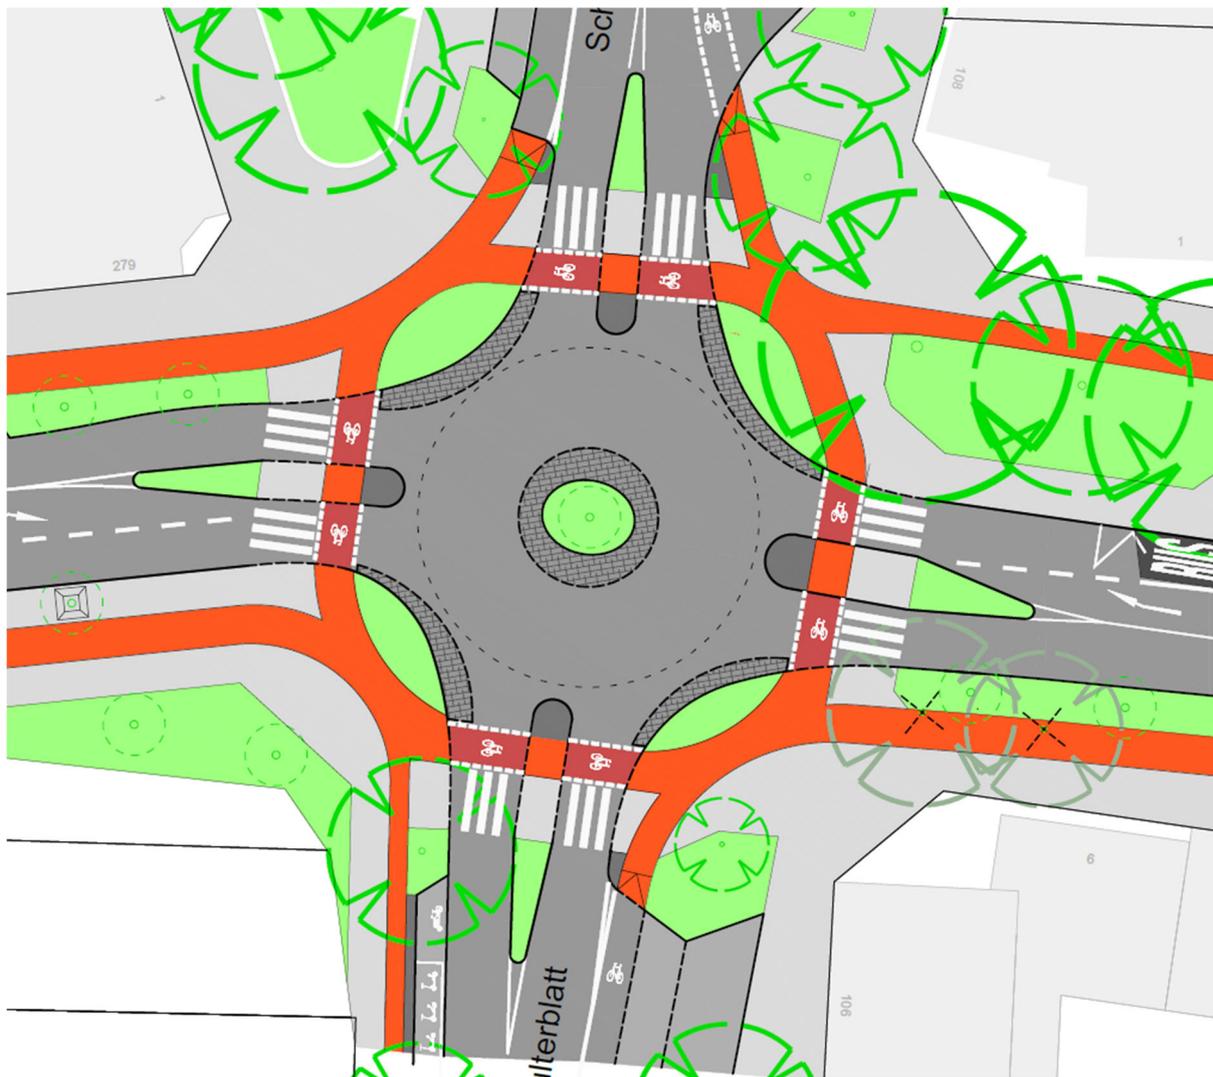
vereinfachter Lageplan Variante Kreisverkehr, LSBG
